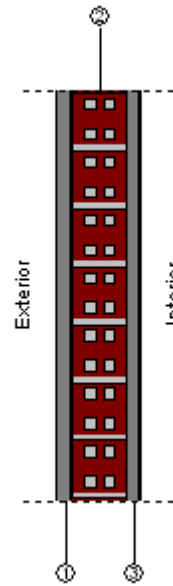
Detalle constructivo de los componentes de la fachada del garaje.
